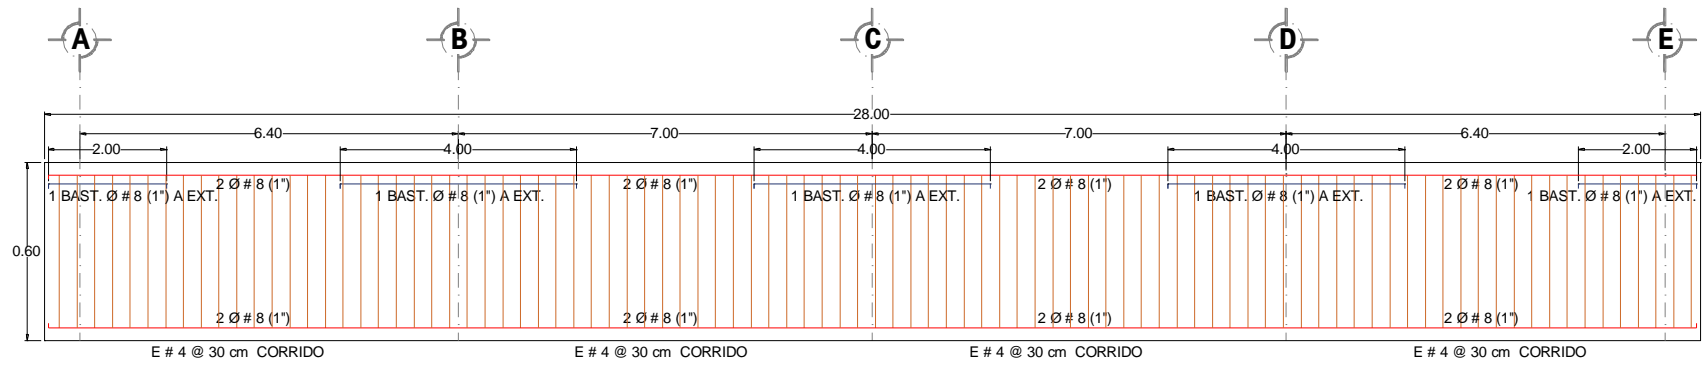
Detallado de armado de vigas y columnas del marco de 9 niveles con base a la hipótesis de las NTCC-04.
